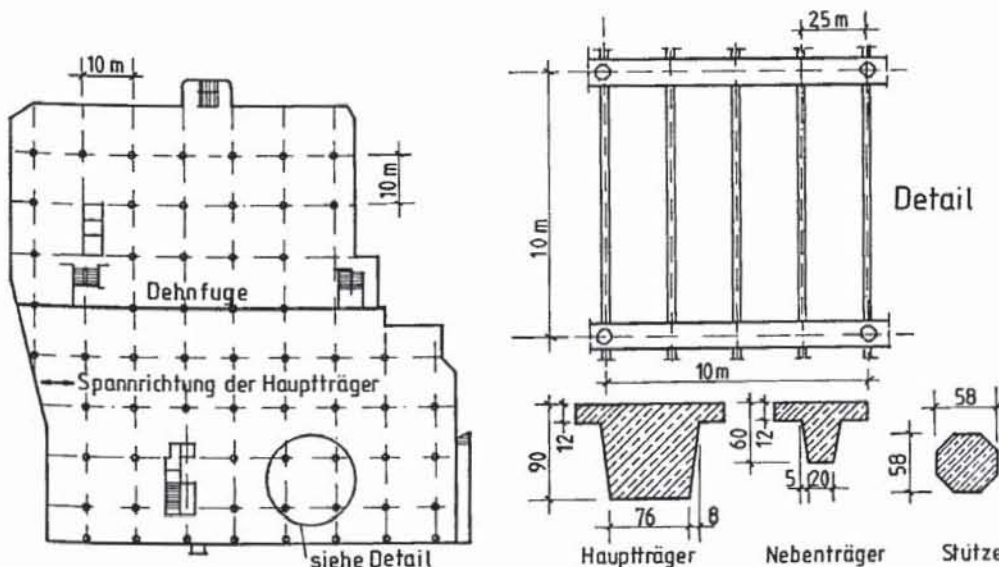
Grundriß, statisches System und Querschnitt der Tragelemente des Einkaufszentrums Heilbronn
